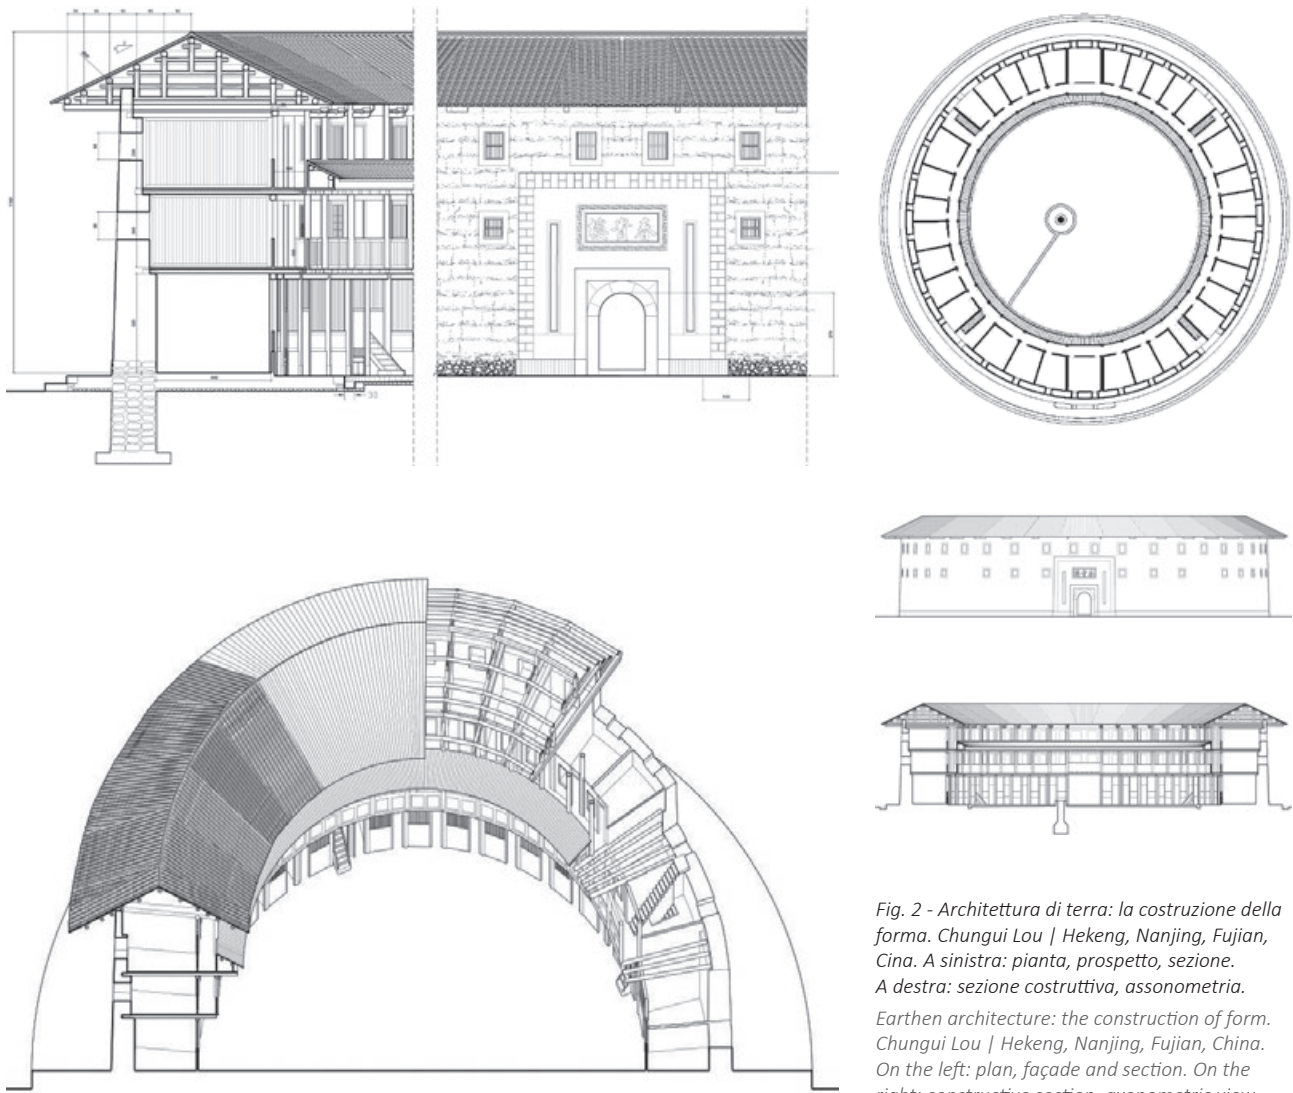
Architettura di terra: la costruzione della forma. Chungui Lou | Hekeng, Nanjing, Fujian, Cina. A sinistra: pianta, prospetto, sezione. A destra: sezione costruttiva, assonometria.
